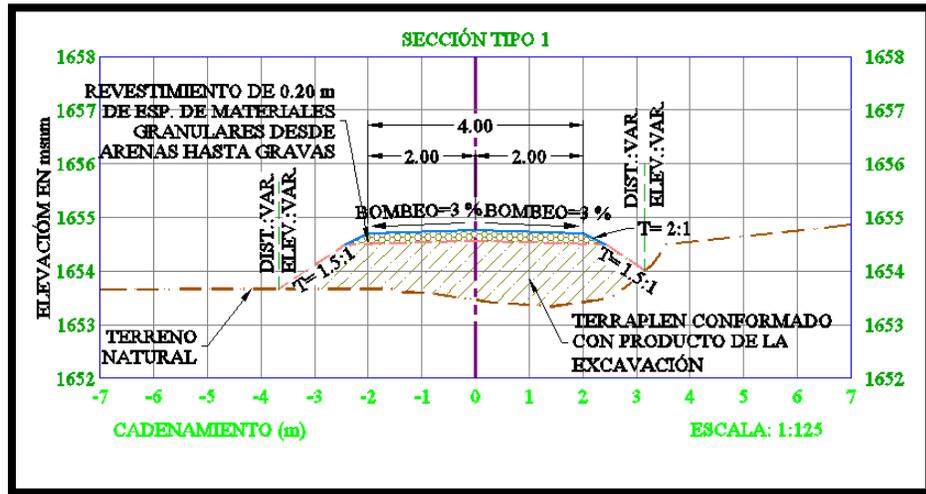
Sección tipo 1 de los cruces de vehiculares sobre el canal de conducción.
